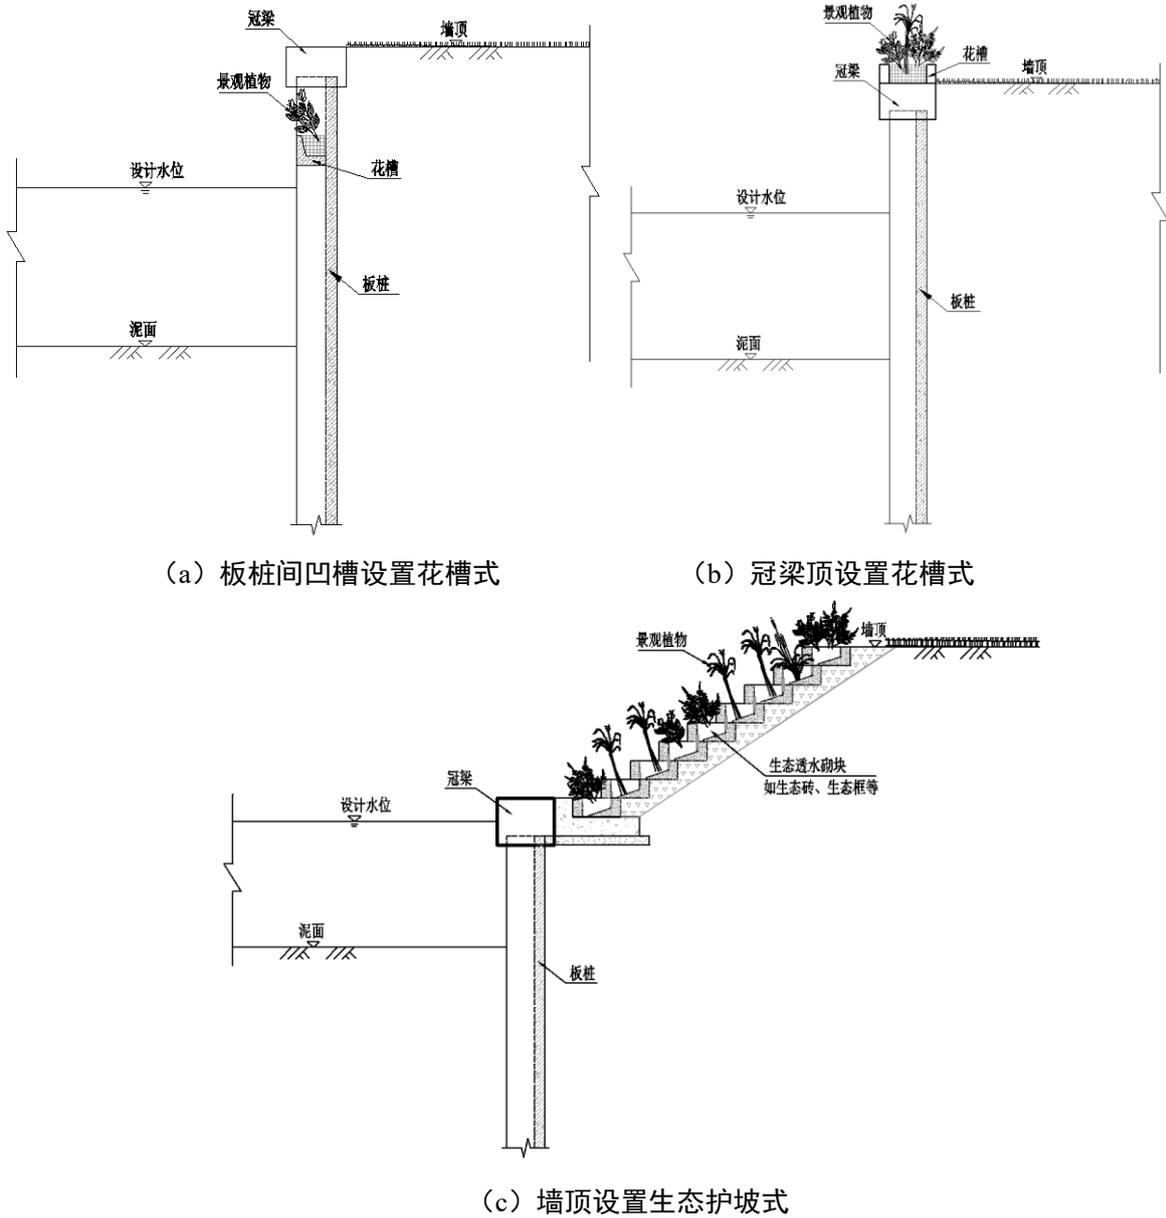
预应力混凝土 U 形板桩挡墙生态布置形式示意图
